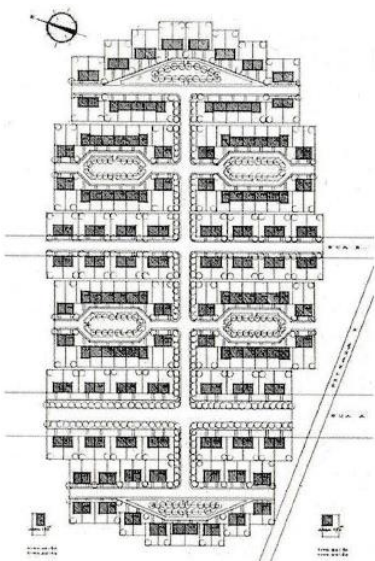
Planta do bairro de Casas Económicas do Bom João, Faro, 1941
